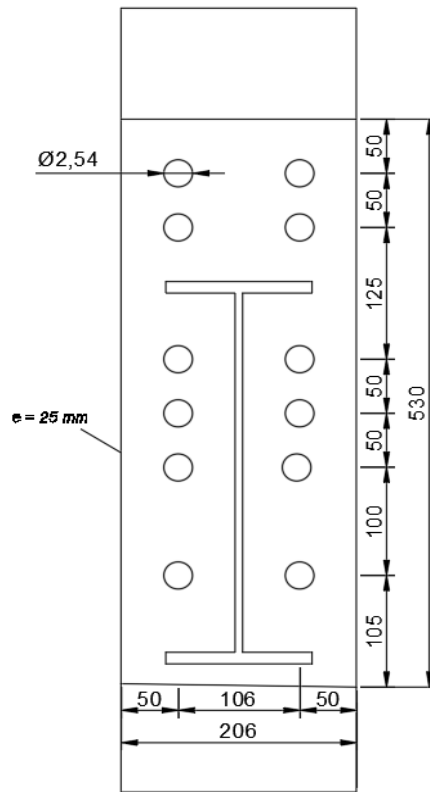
Conexão dos pórticos centrais (unidades em mm)
